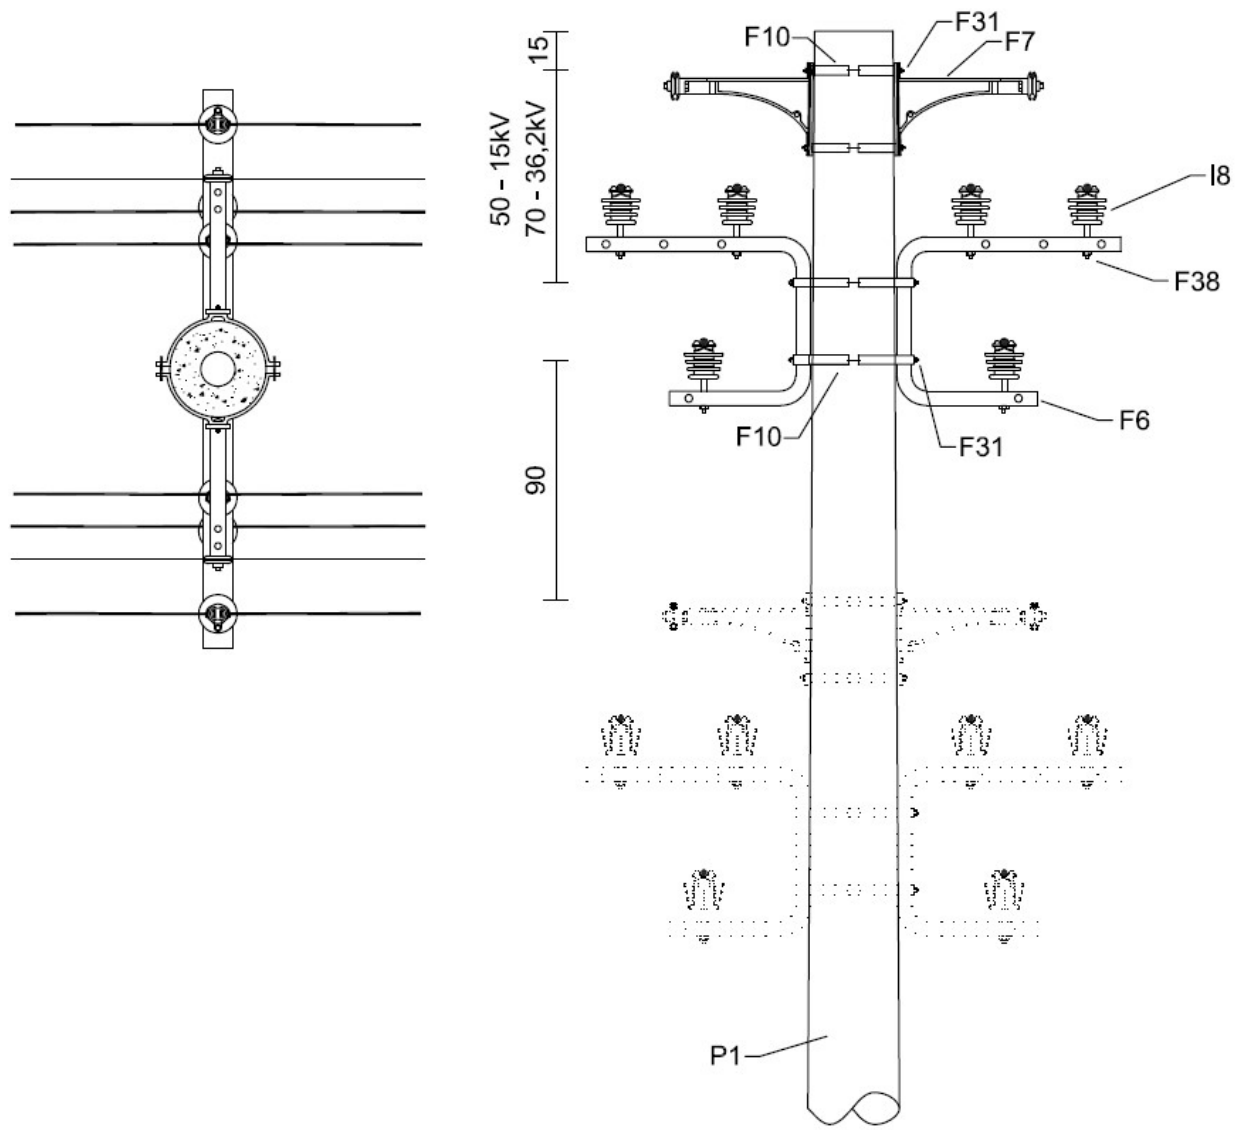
Estrutura CE2.CE2 – Poste de Concreto de Seção Circular
